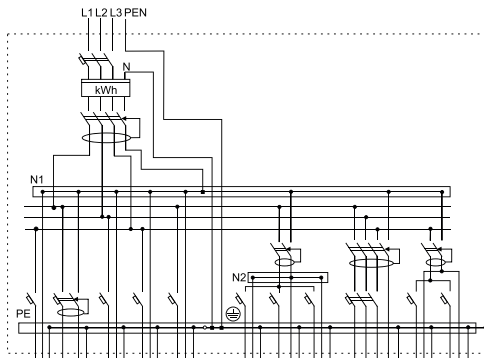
Схема квартирного учетно-группового щитка (для коттеджа)
